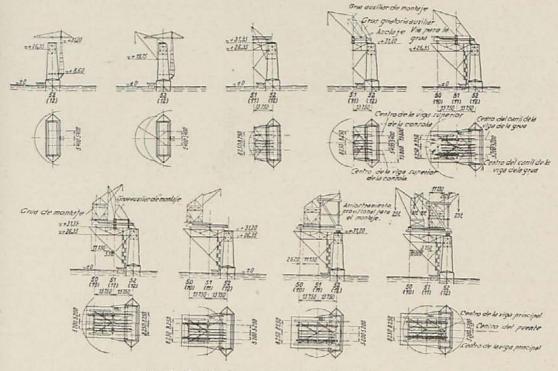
Croquis (alzados y plantas) de las fases del montaje.
